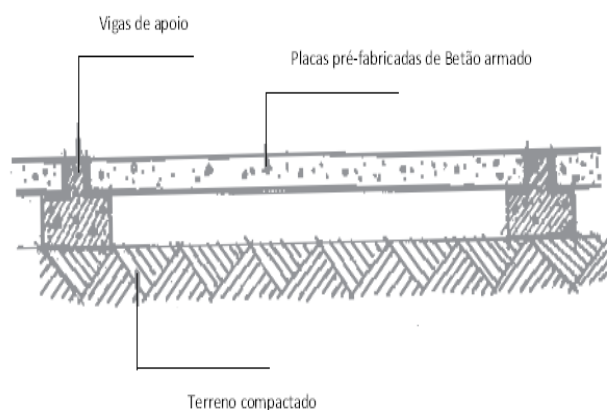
Piso em placas pré-fabricadas de betão armado
